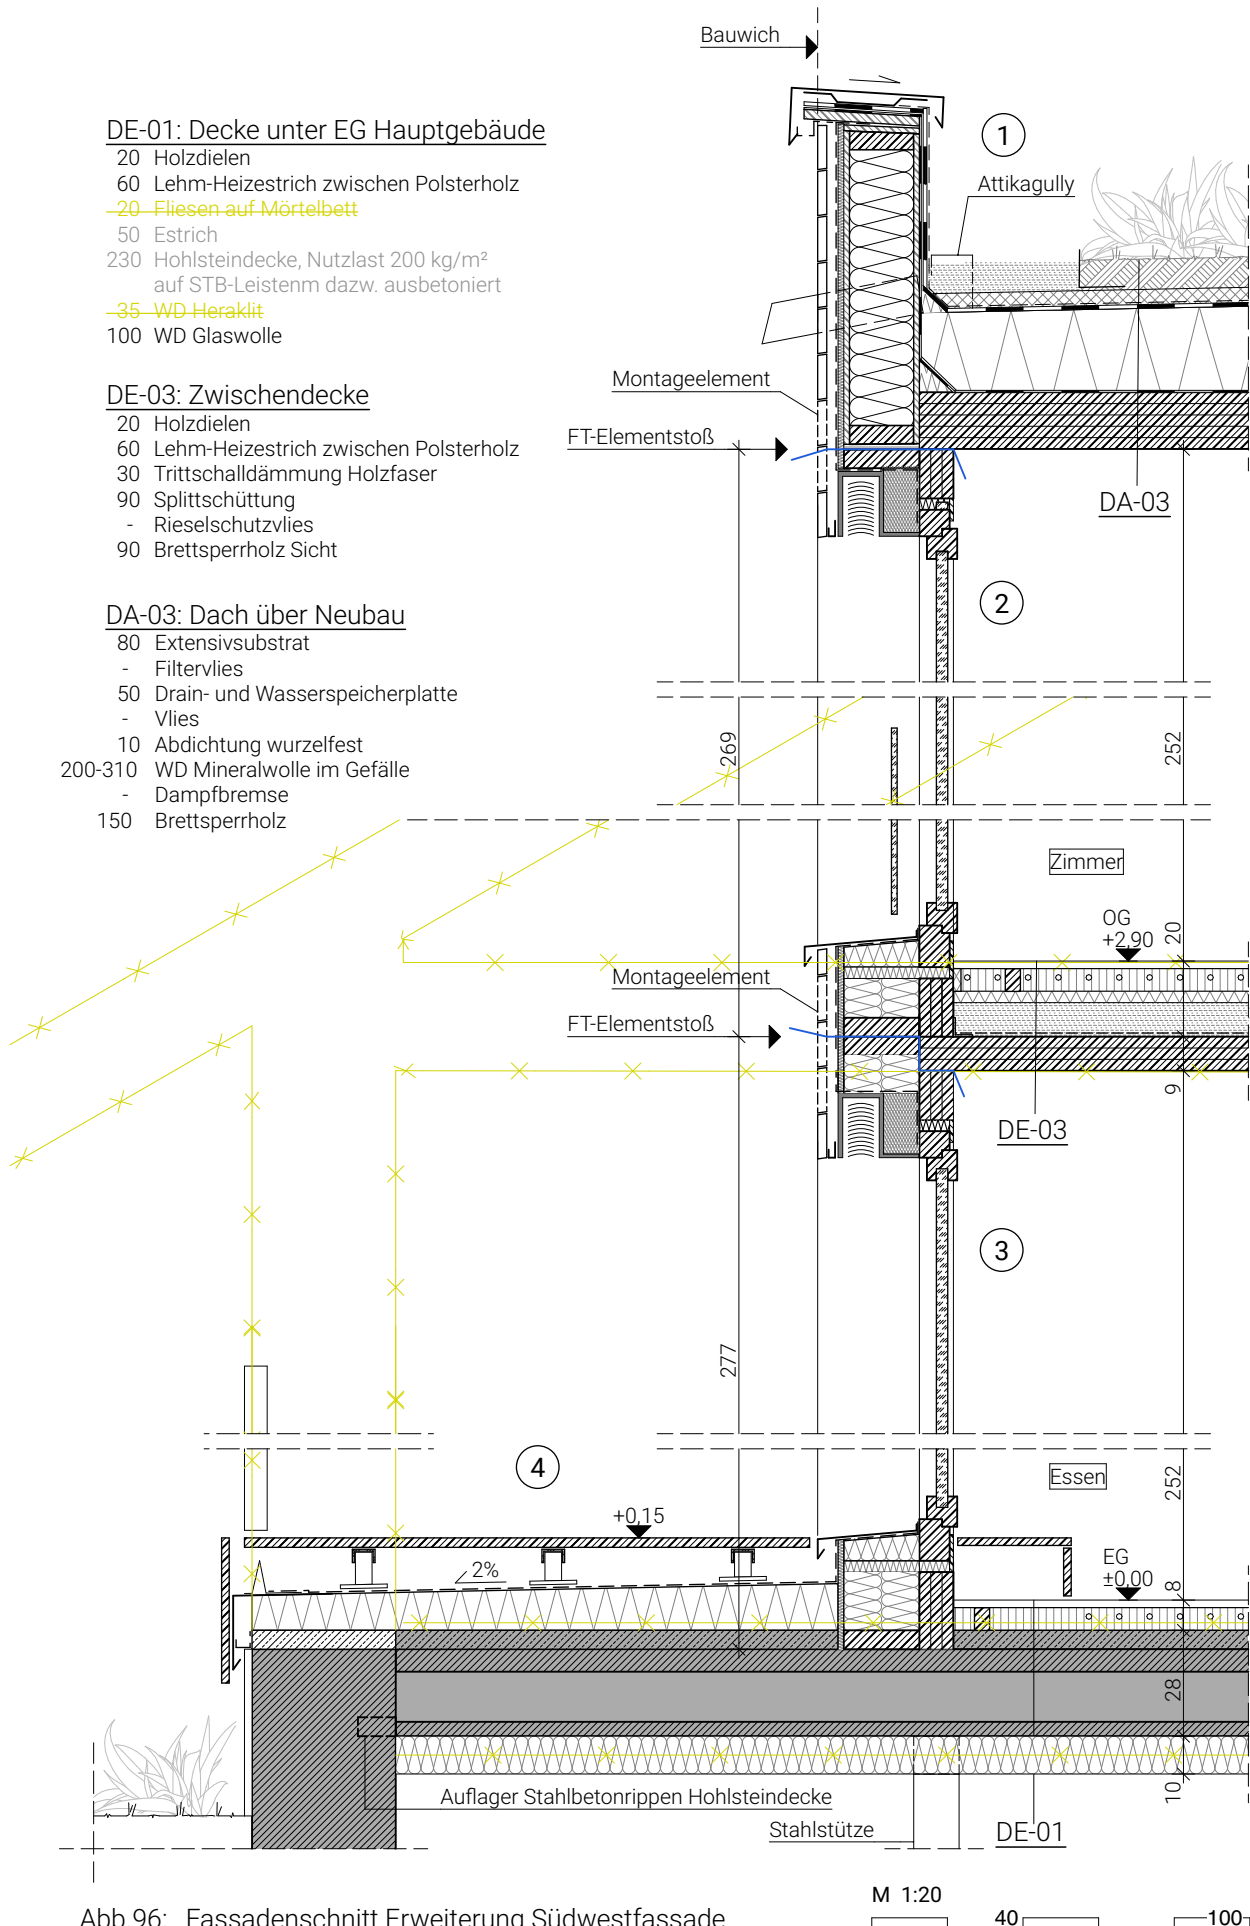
Fassadenschnitt Erweiterung Südwestfassade
